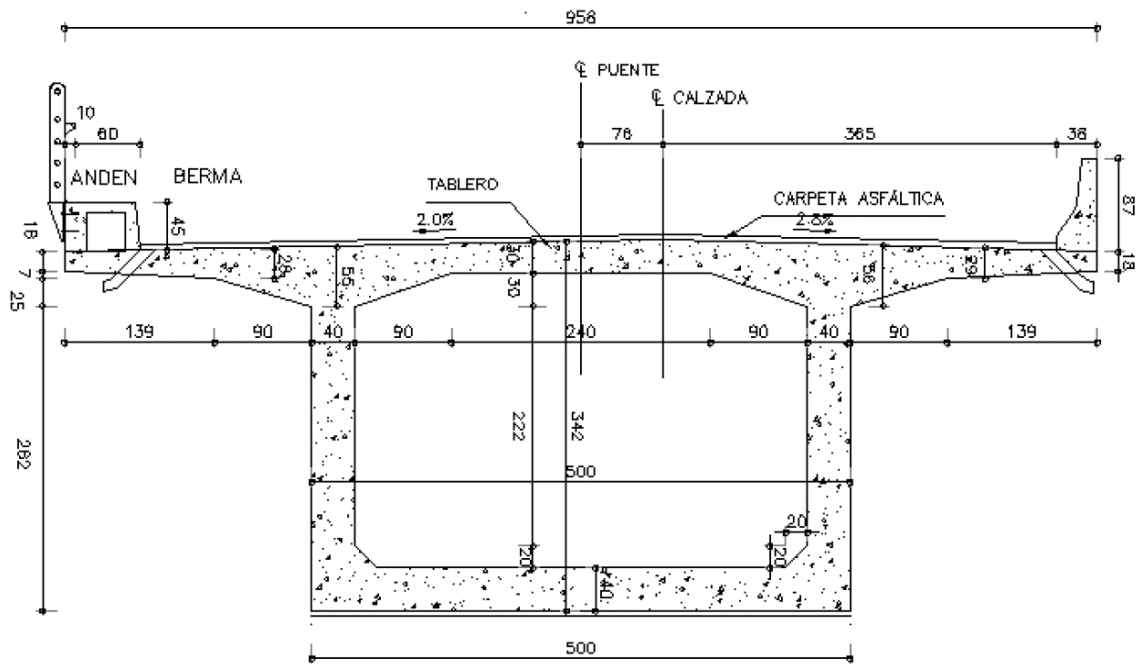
Sección transversal sobre pila de la superestructura del puente Bermúdez.
